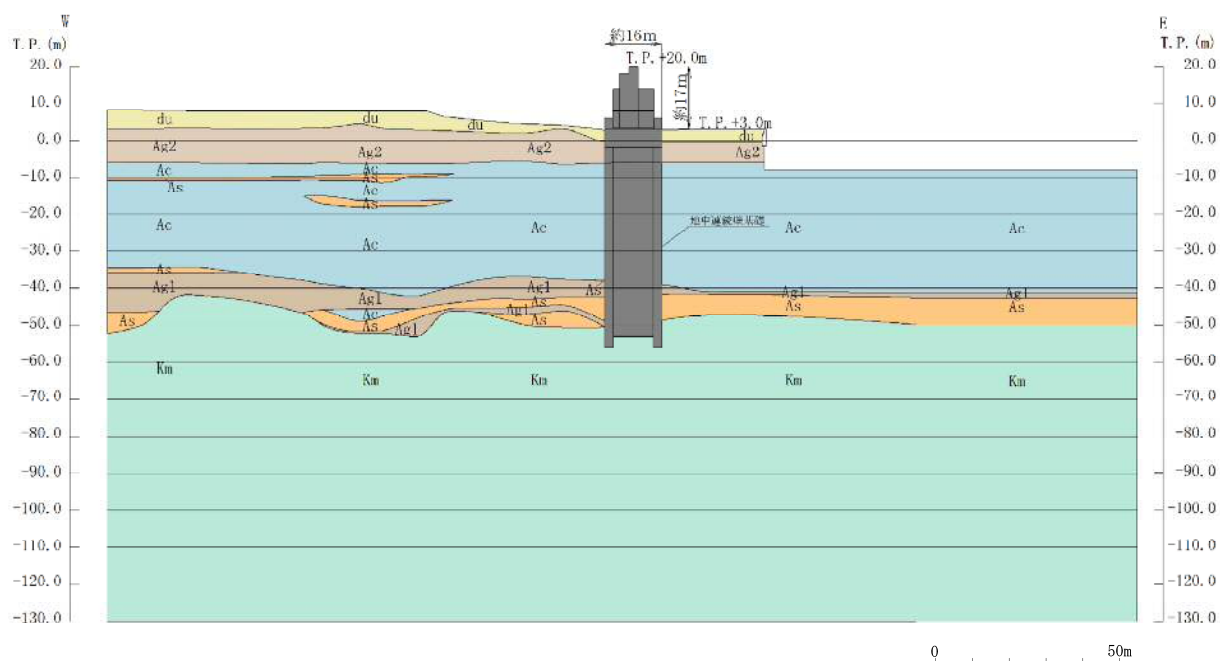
(2) 鋼製防護壁断面図 (②-②断面)
